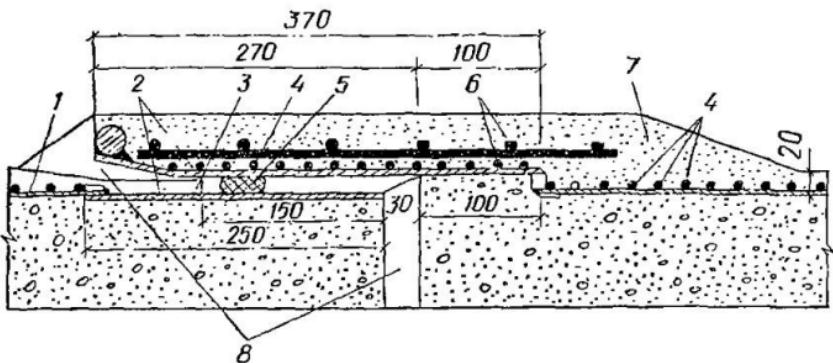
Стыковое соединение железобетонных предварительно напряженных труб
